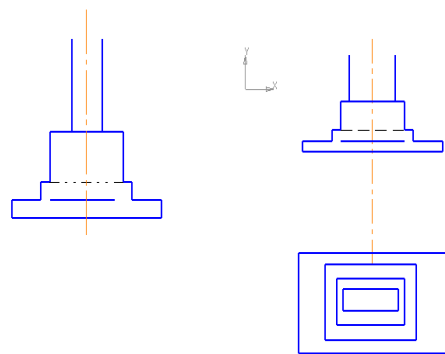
Фундамент под колонну серии КЭ-01-49
